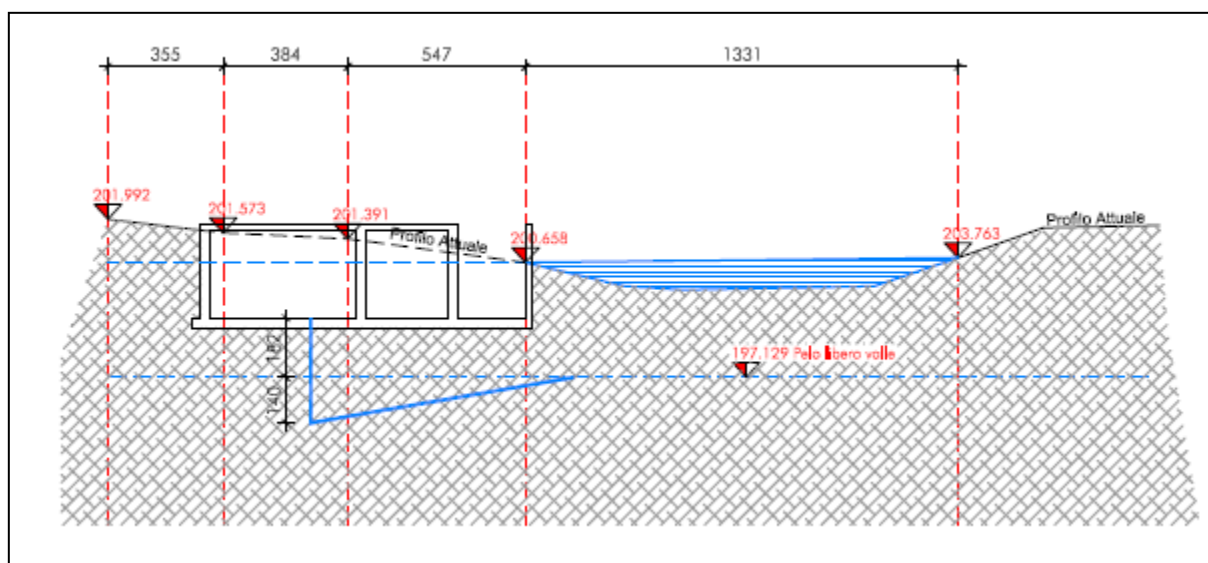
Sezione del locale centrale con vista a valle della briglia con il vano di alloggiamento della turbina e lo scarico di restituzione delle acque turbinare
